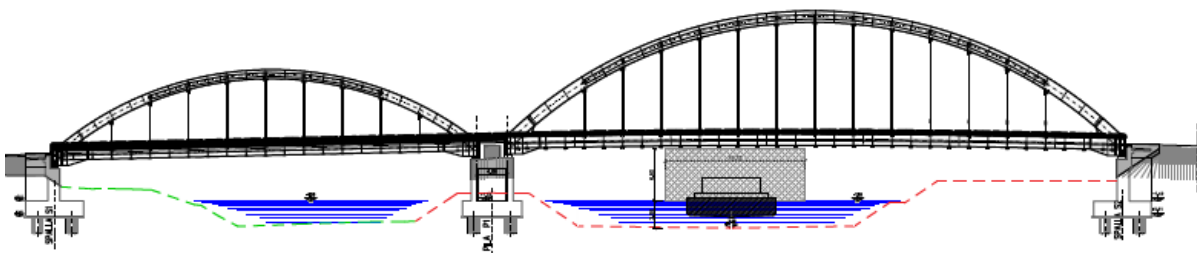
Prospetto del nuovo Ponte di Final di Rero
